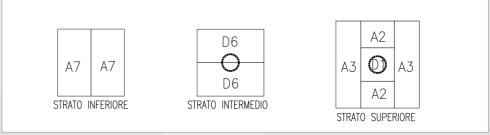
Disposizione dei moduli FAST SITE® SYSTEM 30
